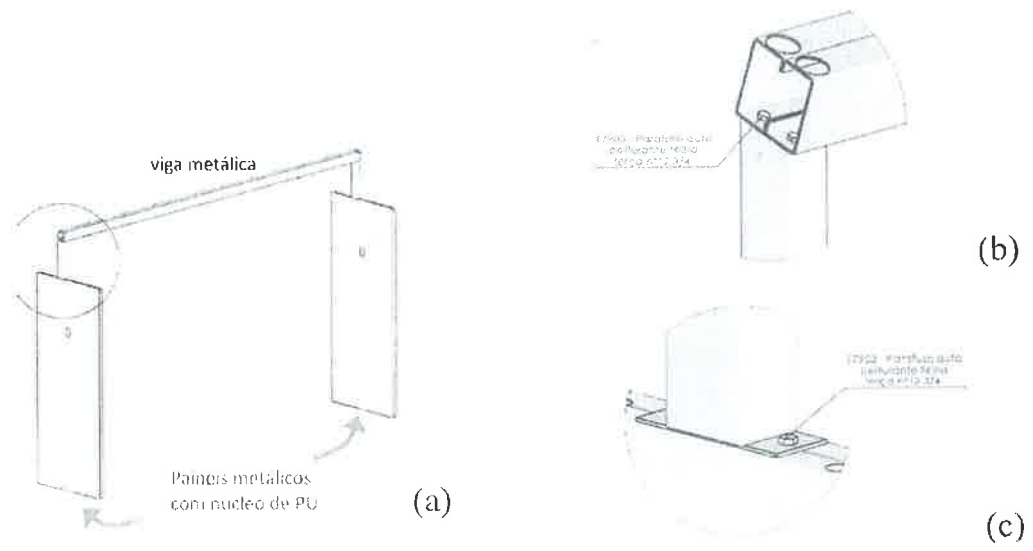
(a) Vista geral da viga metálica composta por dois perfis C; (b) detalhe da fixação da viga metálica no pontalete metálico; (c) detalhe da fixação do pontalete no painel vertical do Sistema Construtivo Casa Modular Fischer.
